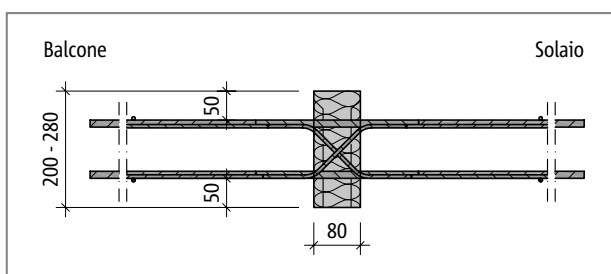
Schöck Isokorb® tipo D con CV50, sezione del prodotto
